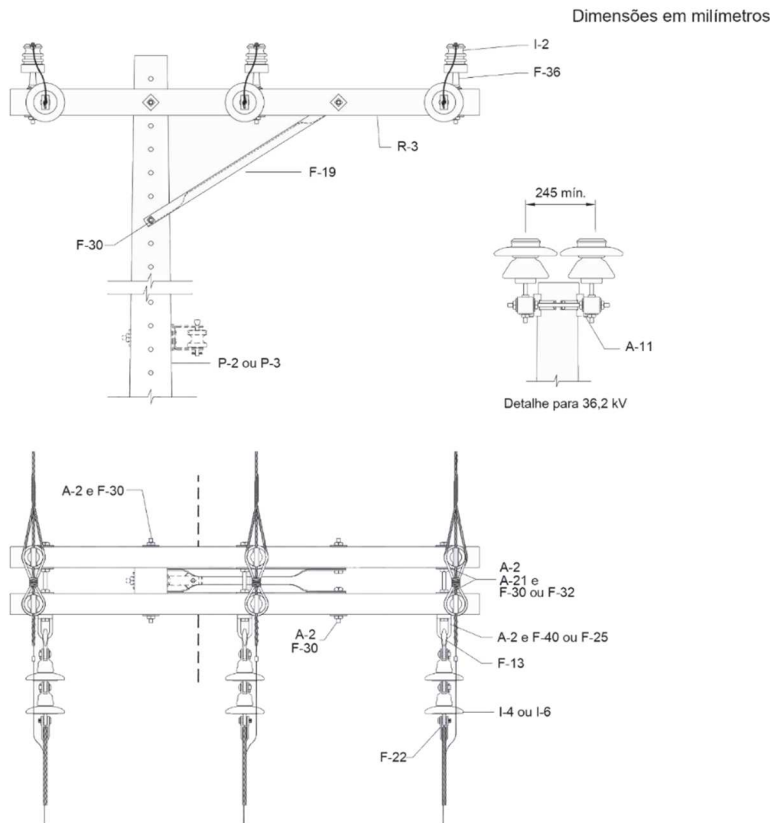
Primário – Estrutura M3-2 – Poste de concreto de seção circular
